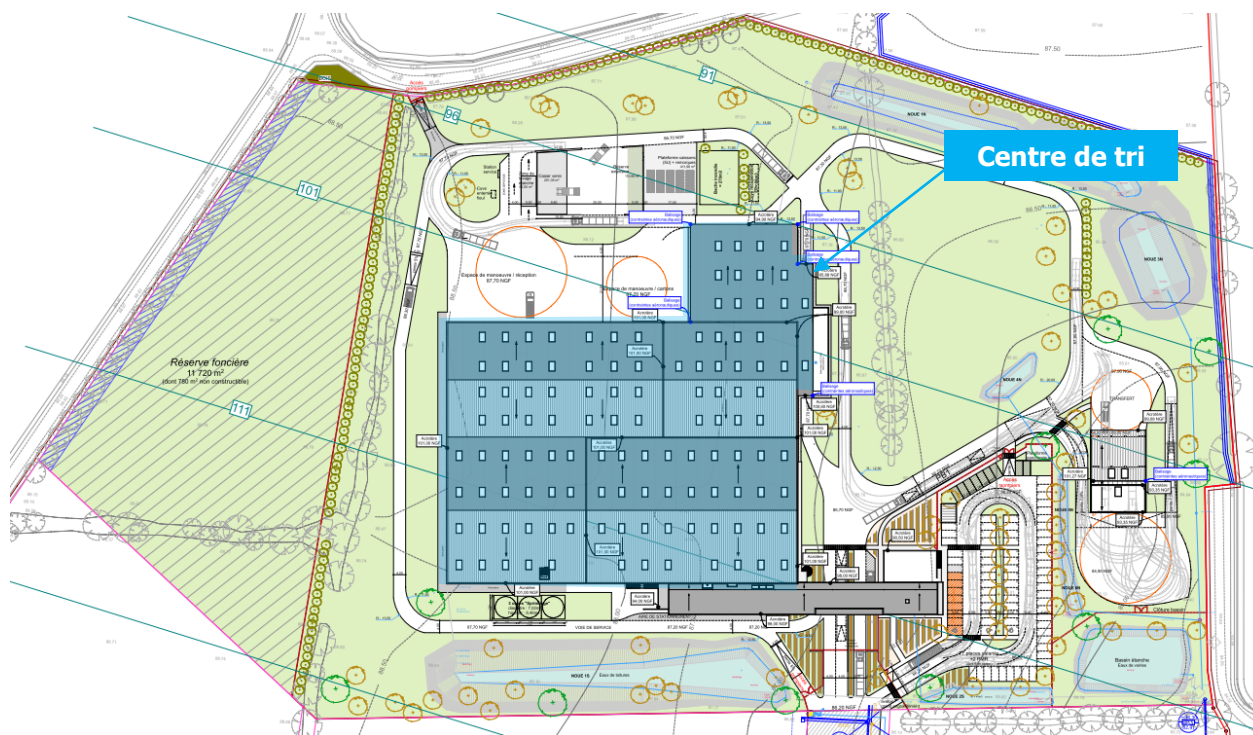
PLAN D'IMPLANTATION DU PROJET
